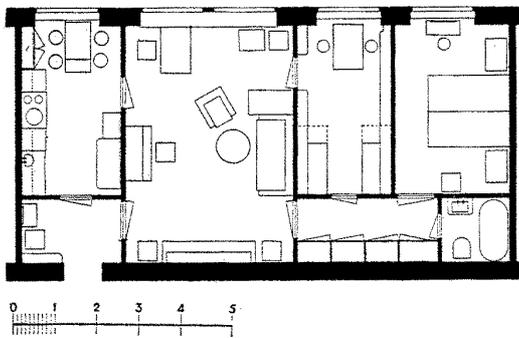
Gustav Clason: Grundriss der Mietwohnung 5.
